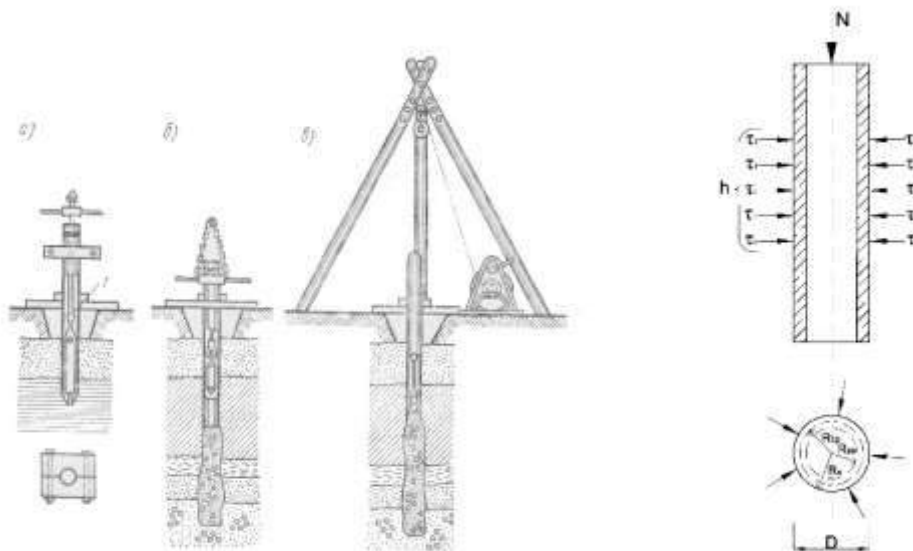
I) Схема виготовлення палі Страуса: а) Буріння свердловини; б) Подача бетону в трубу; в) Трамбування бетону; II) Конструкція пальової основи і діючі зусилля: N – вертикальне навантаження, f – зусилля зщеплення палі з ґрунтом, h – товщина шару несучої частини палі в ґрунті. II) Тонкостінна паля, виготовлена методом пресування в ґрунті за новітньою технологією.
